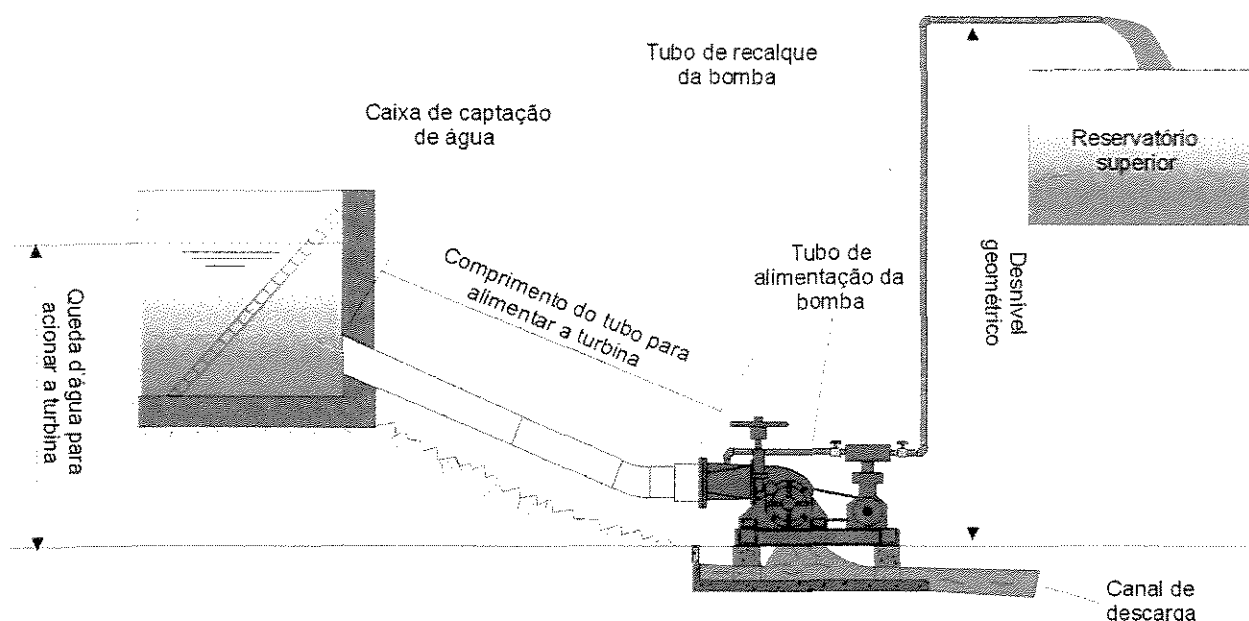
Esquema de instalação do conjunto turbina bomba
